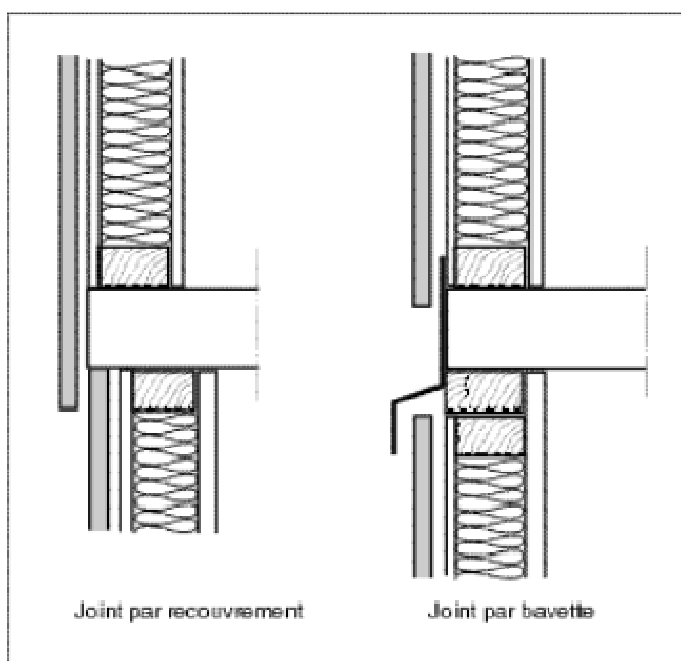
Traitement des joints horizontaux entre panneaux.
